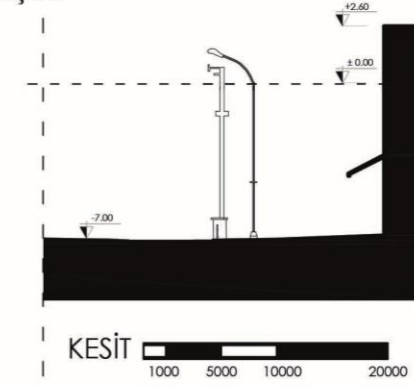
Mekân bölümü 6 plan, kesit, görünüş, fotoğraflar ve deneyim yürüyüşü raporu
